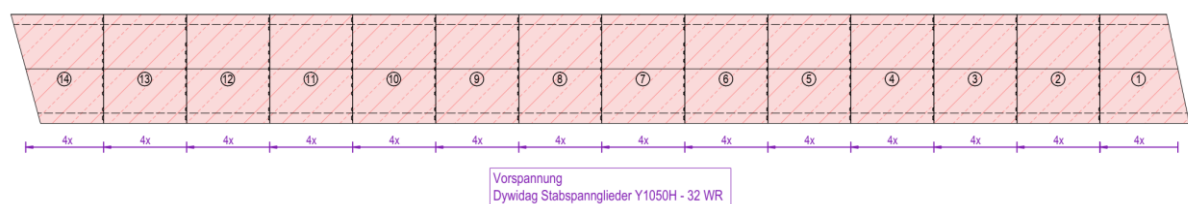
Übersicht vorgefertigte Elemente, Grundriss
